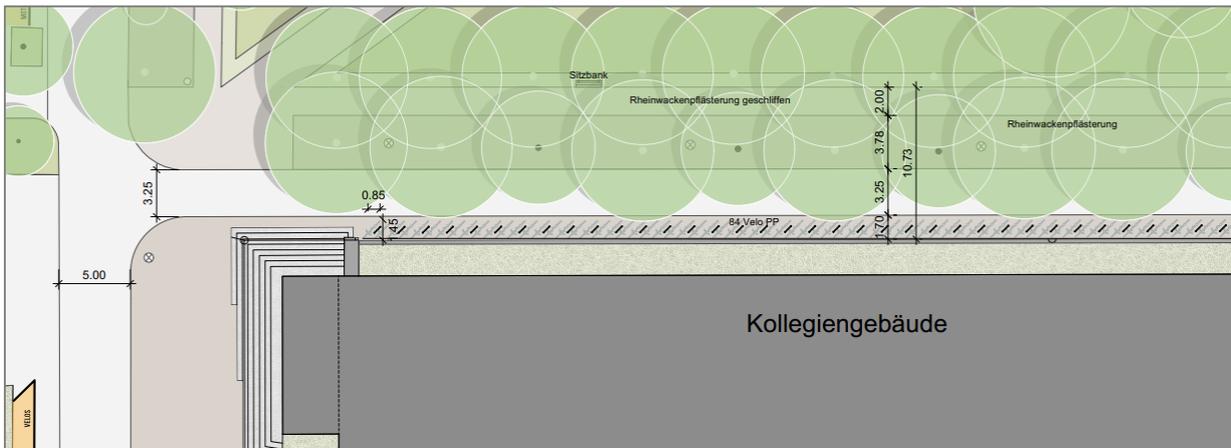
Situationsplan Vorprojekt, Detailansicht Einfahrt vom Spalengraben Richtung Petersgraben entlang Kollegengebäude, vermasst
